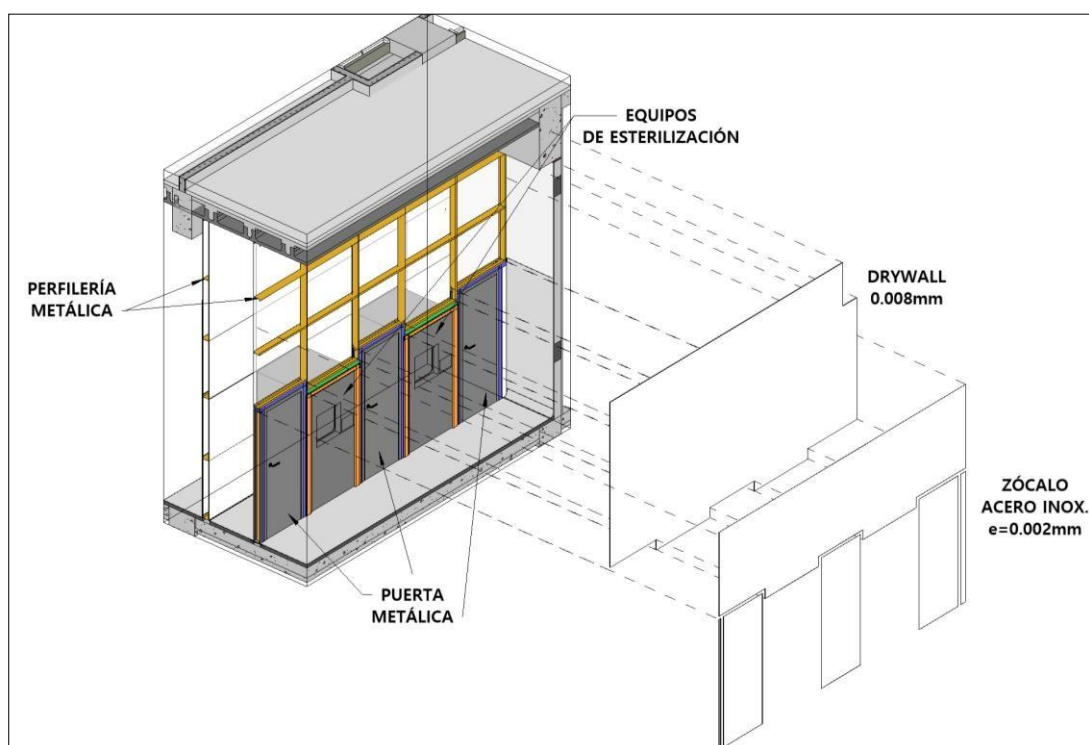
Isometría constructiva de Sistema de Construcción en Seco
